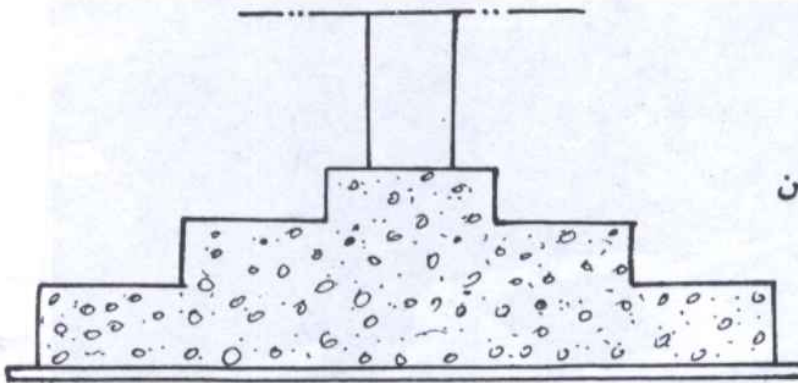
٤) نموذج لأساس منفرد مسبق الصنع
